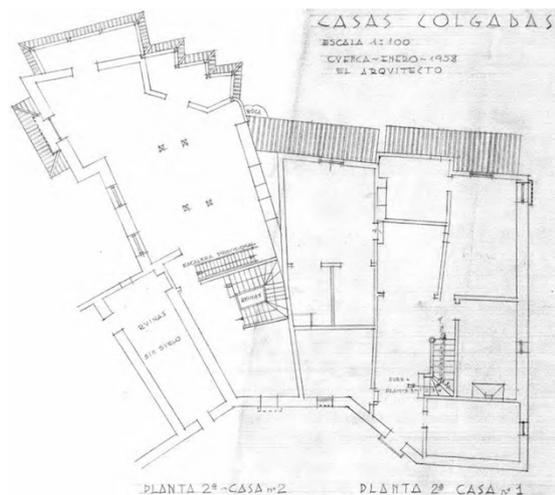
Proyecto para las fachadas de Las Casas Colgadas. Planta segunda según Fernando Torrallas. IBÁÑEZ MARTÍNEZ, P.M. P. 261
